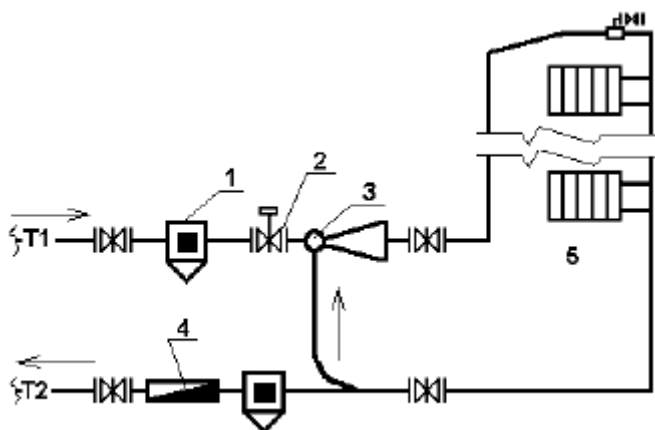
Тепловой узел системы отопления, присоединяемой к теплосетям по открытой схеме: 1 – грязевик; 2 – регулятор расхода; 3 – гидроэлеватор; 4 – расходомер; 5 – система отопления
